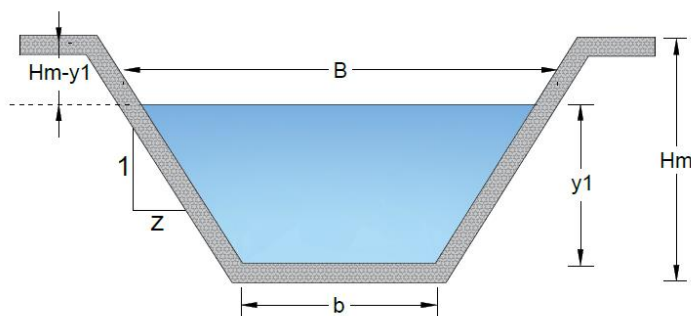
Sección transversal de un canal trapezoidal. Fuente: Elaboración propia.
